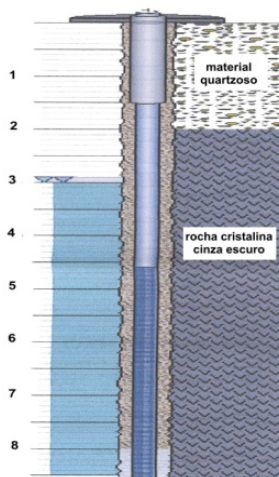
Perfil do piezômetro da Barragem do Clóvis jusante
